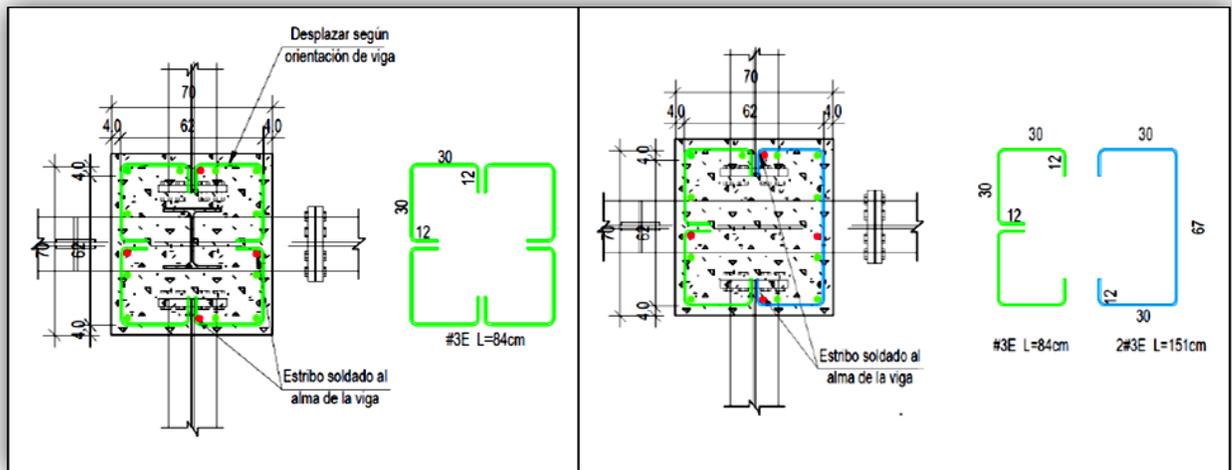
Refuerzo transversal de las columnas de 0.70 m x 0.70 m en los nudos.
